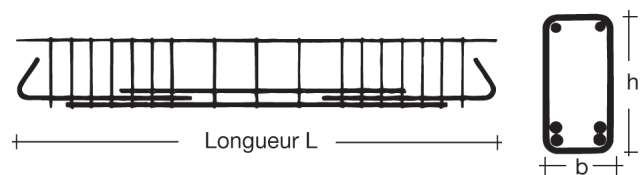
Poutre avec retombée (5 à 20 cm)
